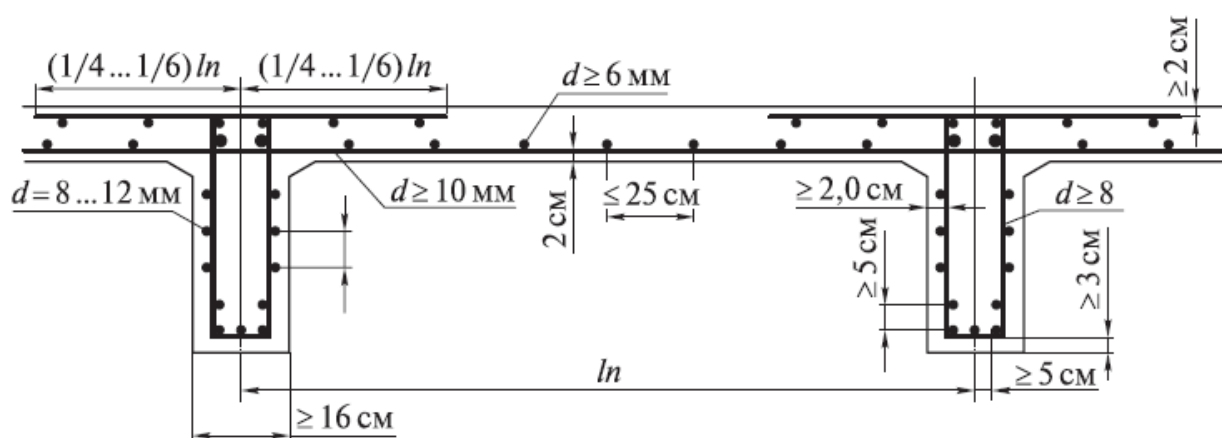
Расположение ненапрягаемой арматуры в плите проезжей части и главных балках пролетного строения
